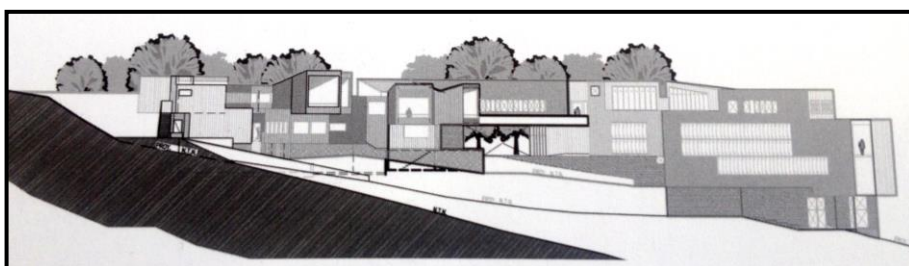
Corte transversal y emplazamiento del inmueble.
